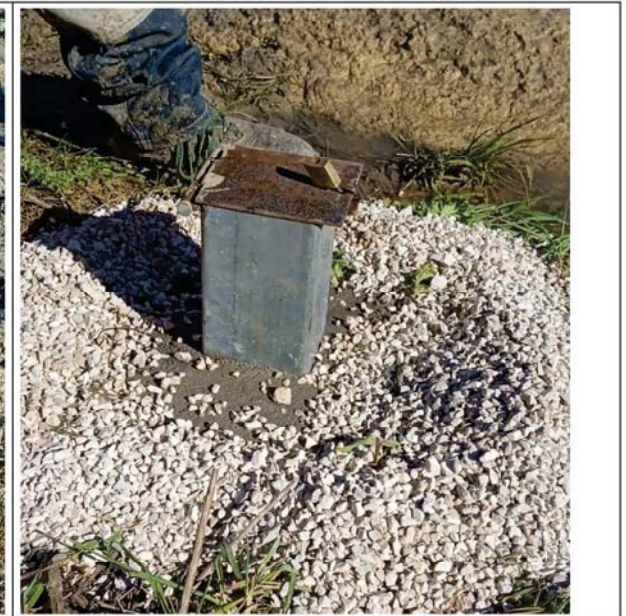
Piezometro installato nel sondaggio S.2-Pz
